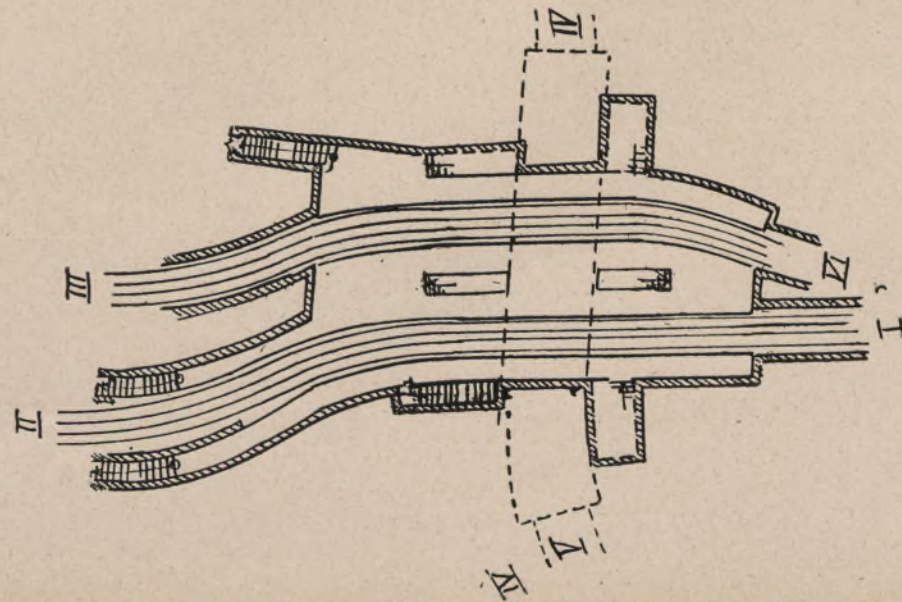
Grundriß des Untergrundbahnhofes bei B.
